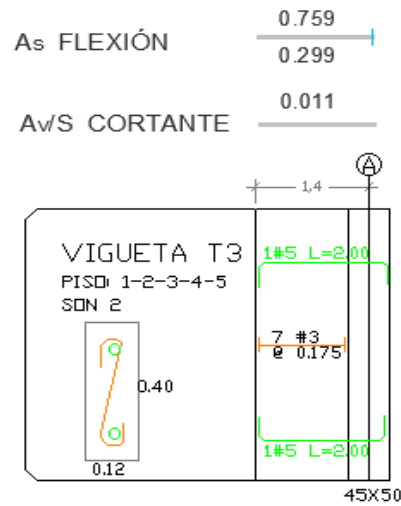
Cuantías obtenidas por esfuerzo a flexión, cortante y despiece de la vigueta tipo 3 de la planta estructural. Fuente: elaboración propia.
